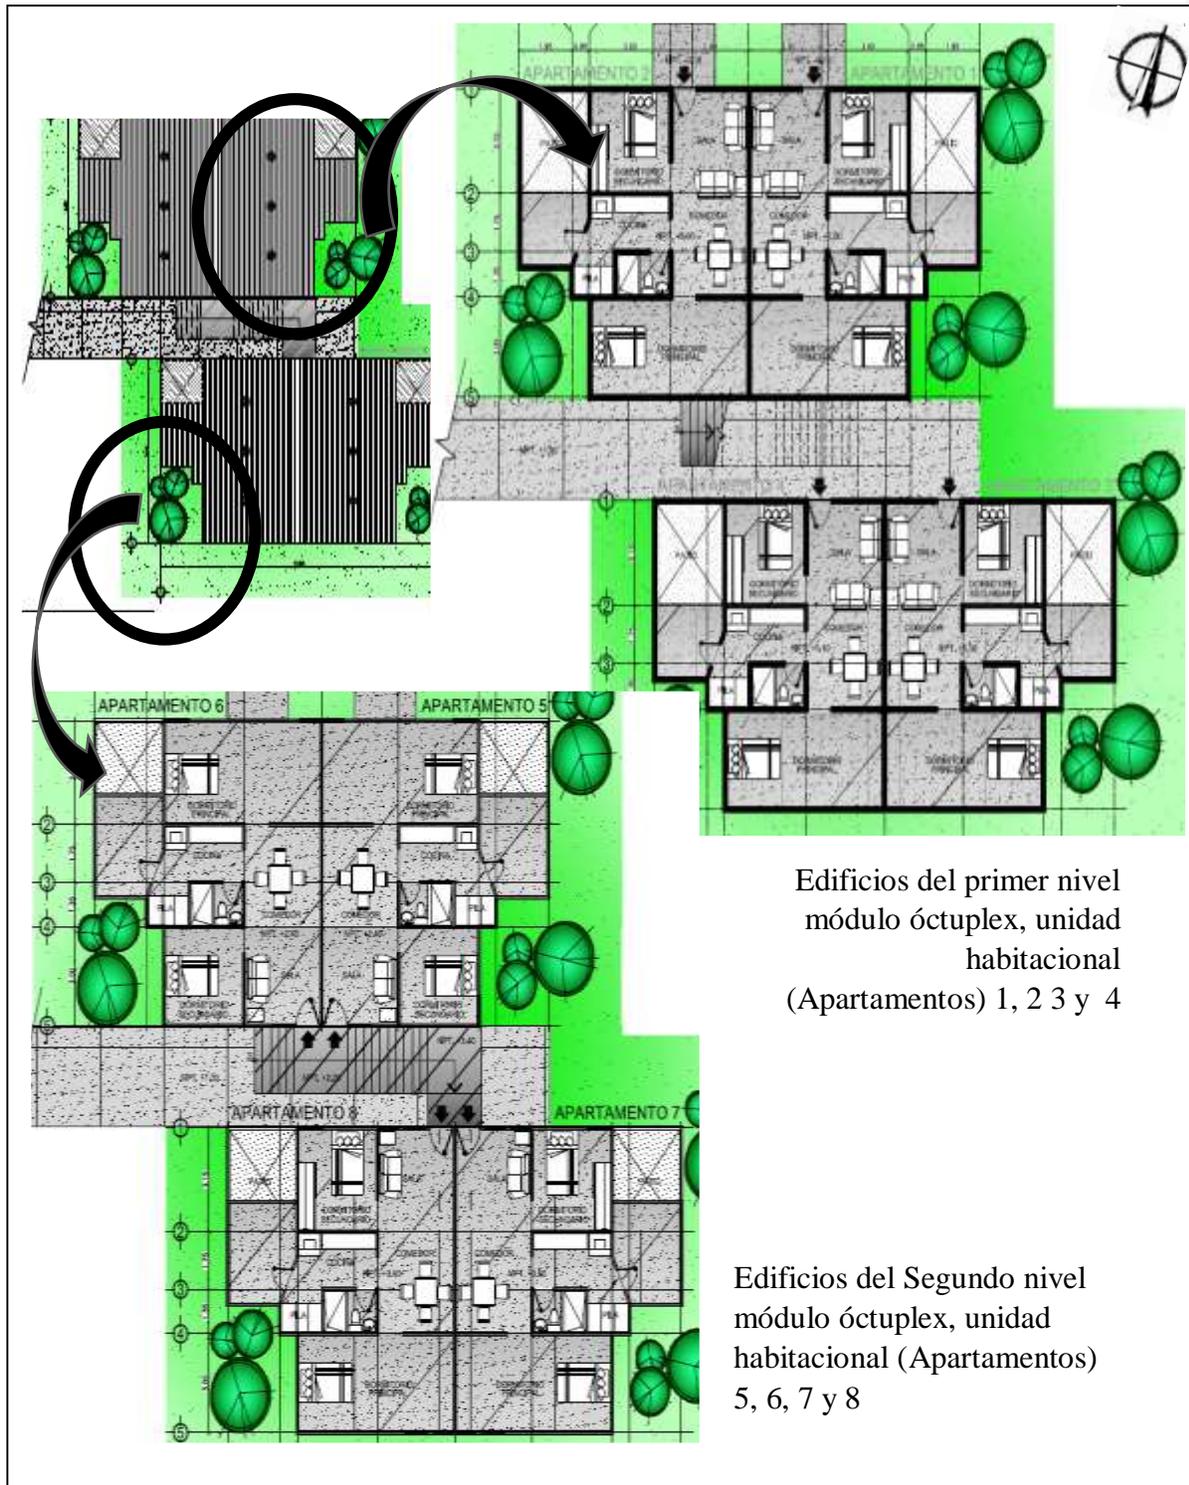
Plano de distribución / Módulo óctuplex típico primer nivel/ situación original
